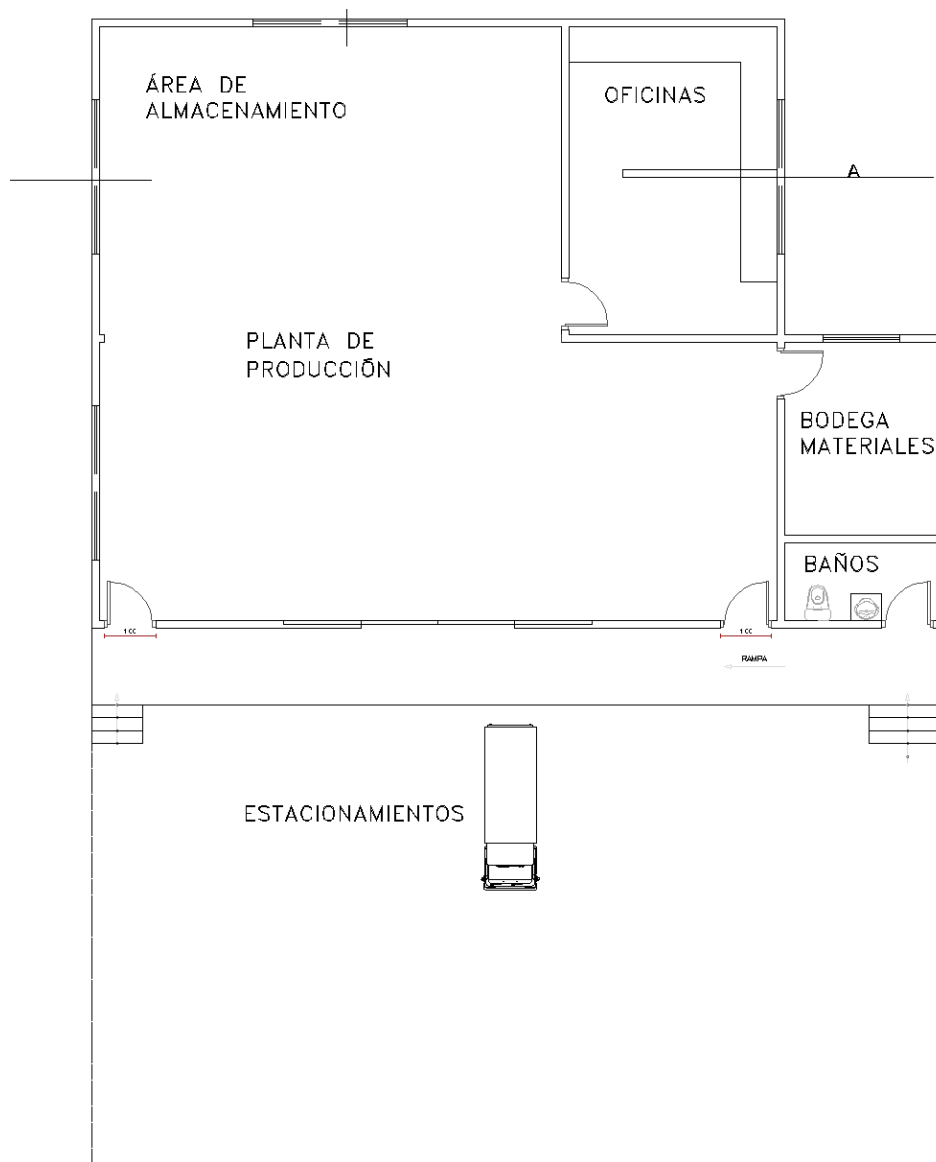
Layout en Planta de la Distribución de la Empresa. Elaboración Propia en AutoCAD.
